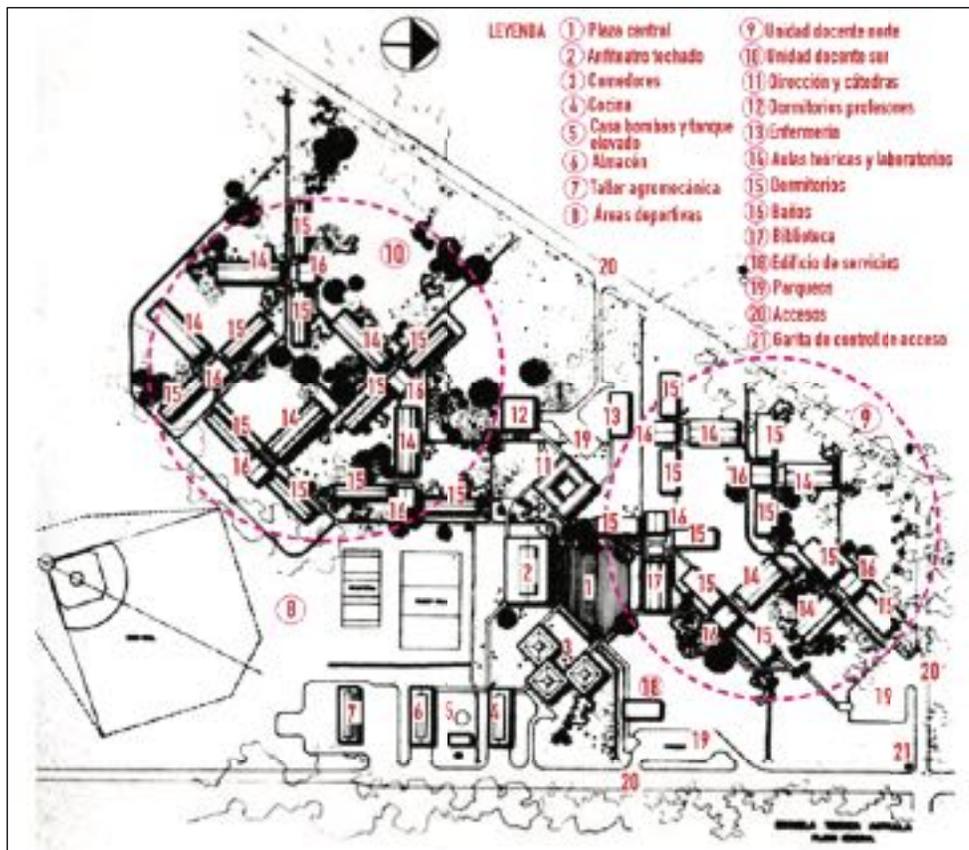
Plano de Plan General, “Escuela Técnica Agraria” (según rótulo que aparece en el plano). Fuente: Plano editado por los autores a partir del aportado por Christian Zecchin.
